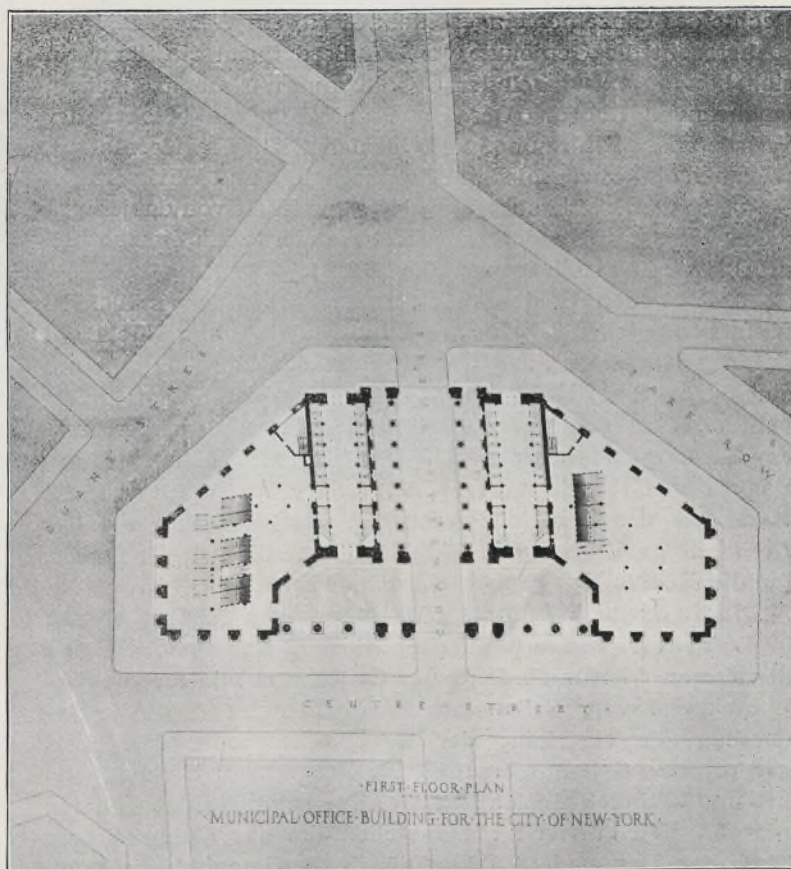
Grundriß des eine Straße überbauenden Gebäudes nebst Lageplan der Umgebung.
